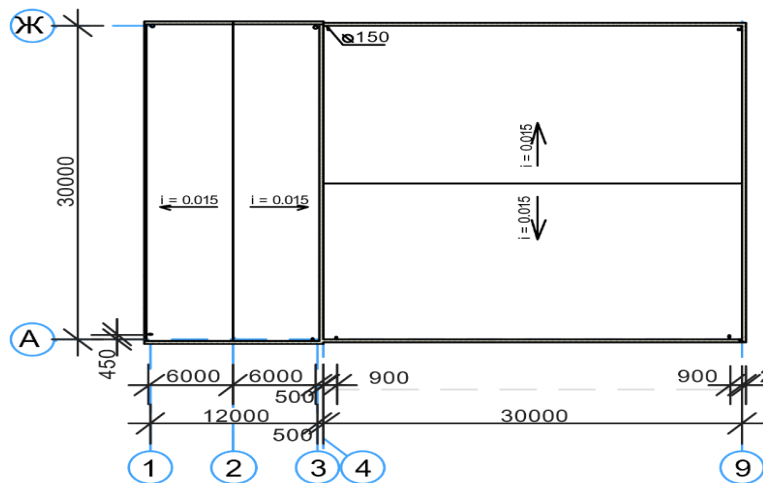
Схема расположения колонн, балок и ферм покрытия
